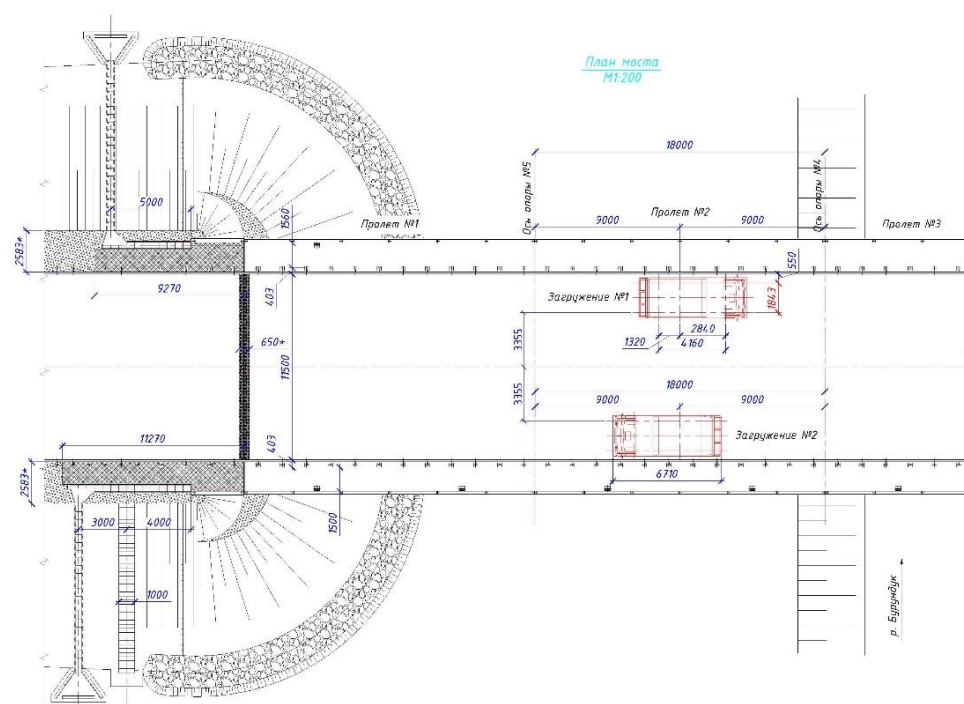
План моста со схемой расположения испытательной нагрузки в 2 вариантах загрузки. Схема выполнена А.А. Банниковым
